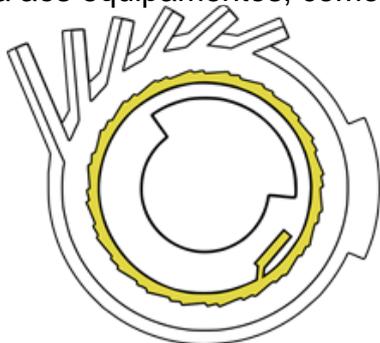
O túnel de blindagem está construído sobre um piso monolítico de concreto armado com 90 centímetros de espessura e suas paredes e coberturas espessas, também em concreto armado com espessura variável entre 80 centímetros e 1,5 metros. Toda a blindagem será construída sem juntas de dilatação e constituirá, ao término da concretagem, em uma peça única com 520 metros de comprimento.
